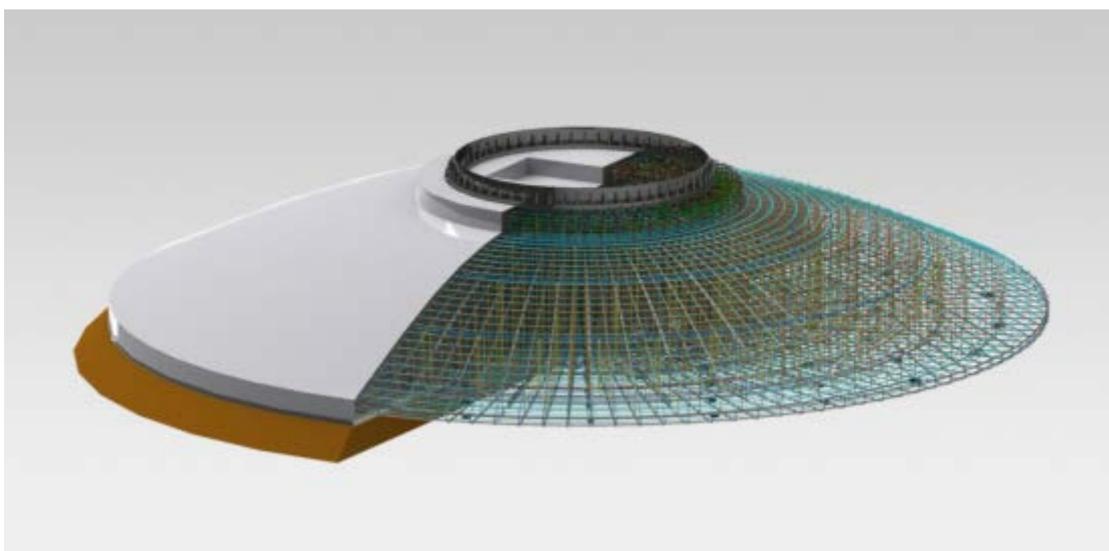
Vista render fondazione Aerogeneratore.
